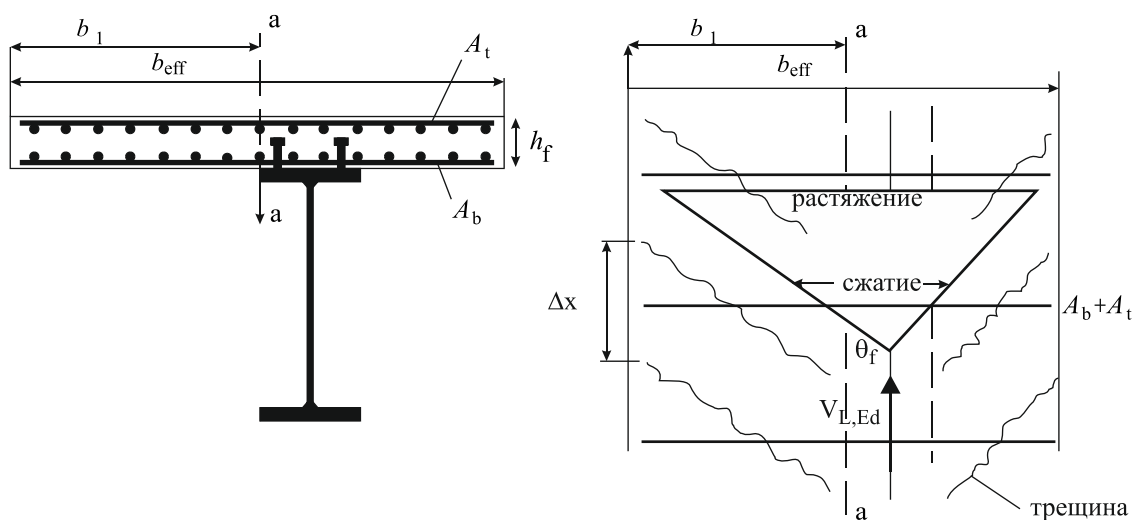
Расчетная модель бетонной плиты при продольном сдвиге [22]
